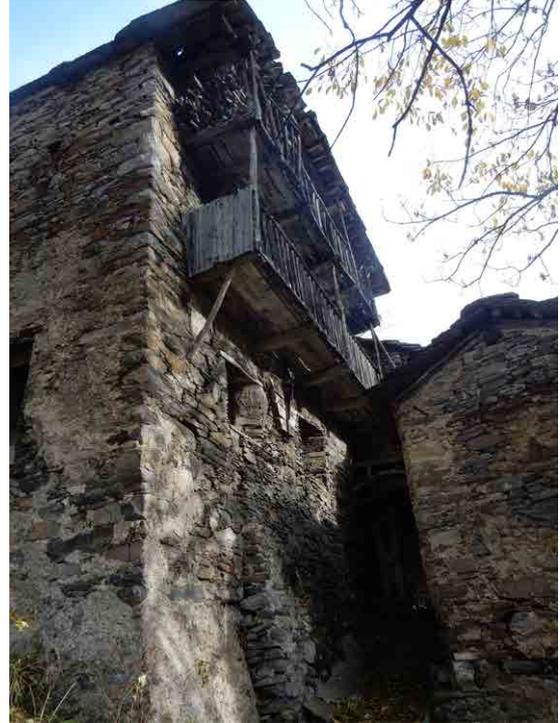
| Balconate sovrapposte e parapetto laterale di protezione (2019)
